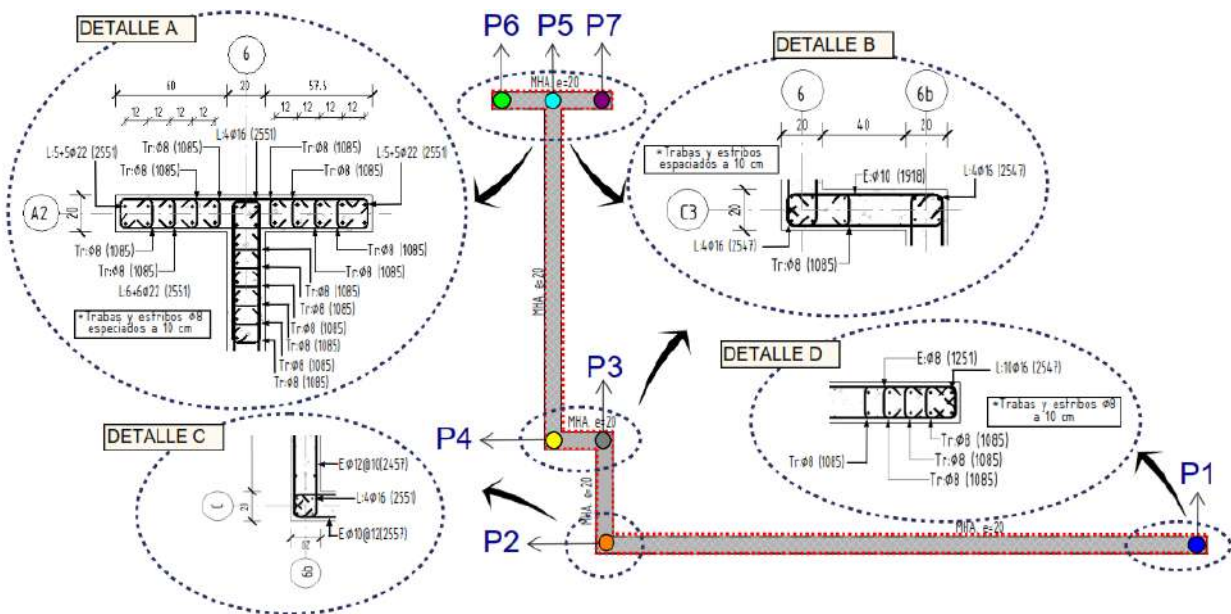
Muro con asimetría seccional compleja desfavorable en X.
